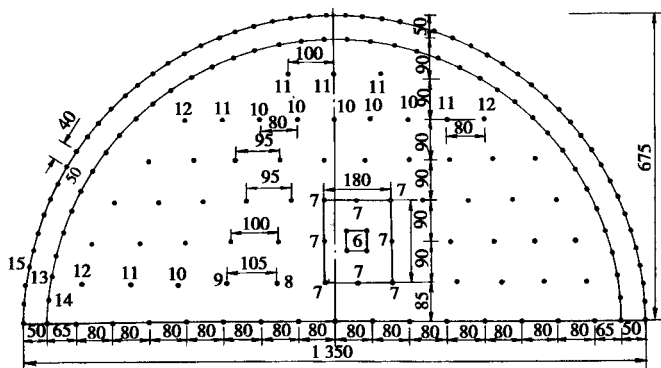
II、III类围岩上半断面炮孔布置图(尺寸单位:cm)
